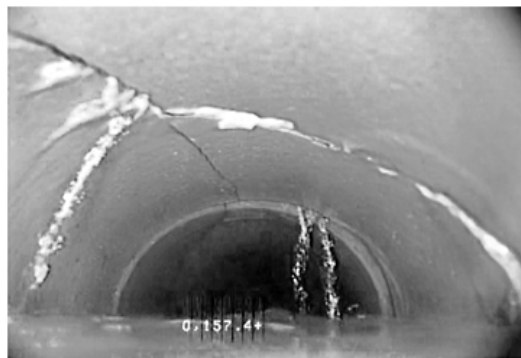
Fissura com infiltração ligeira (Fonte: ASCE,2009)
